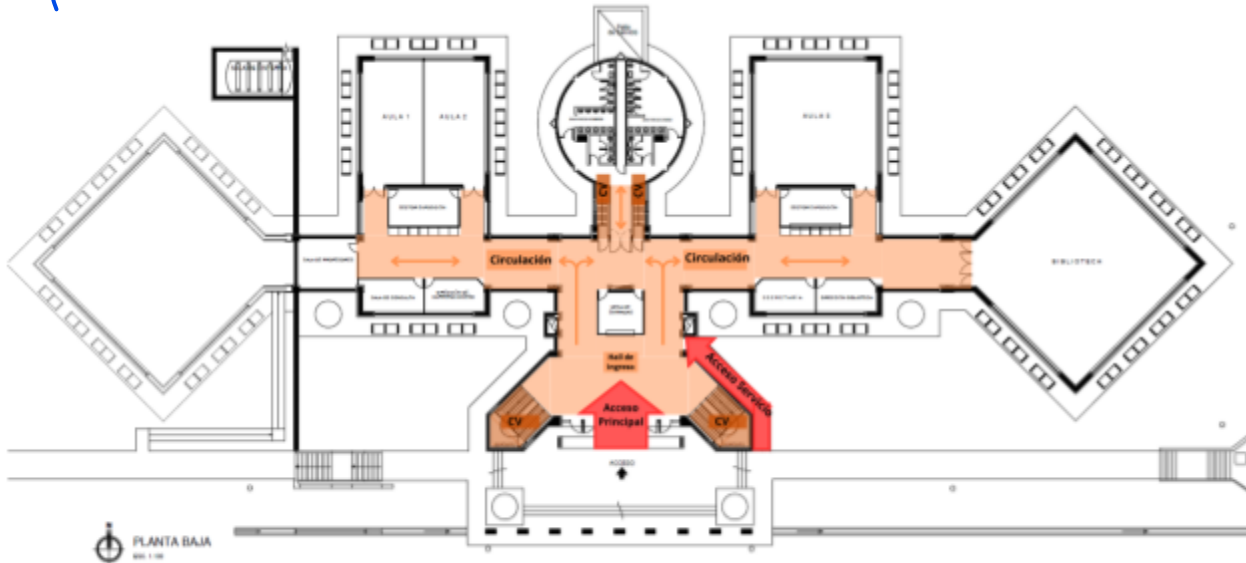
Esquema de las circulaciones horizontales de la planta baja
